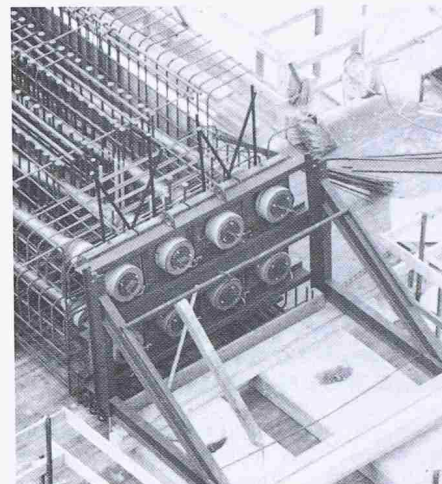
Verankerungsbereich mit Stahlkonstruktion zur Fixierung der Ankerplatten
